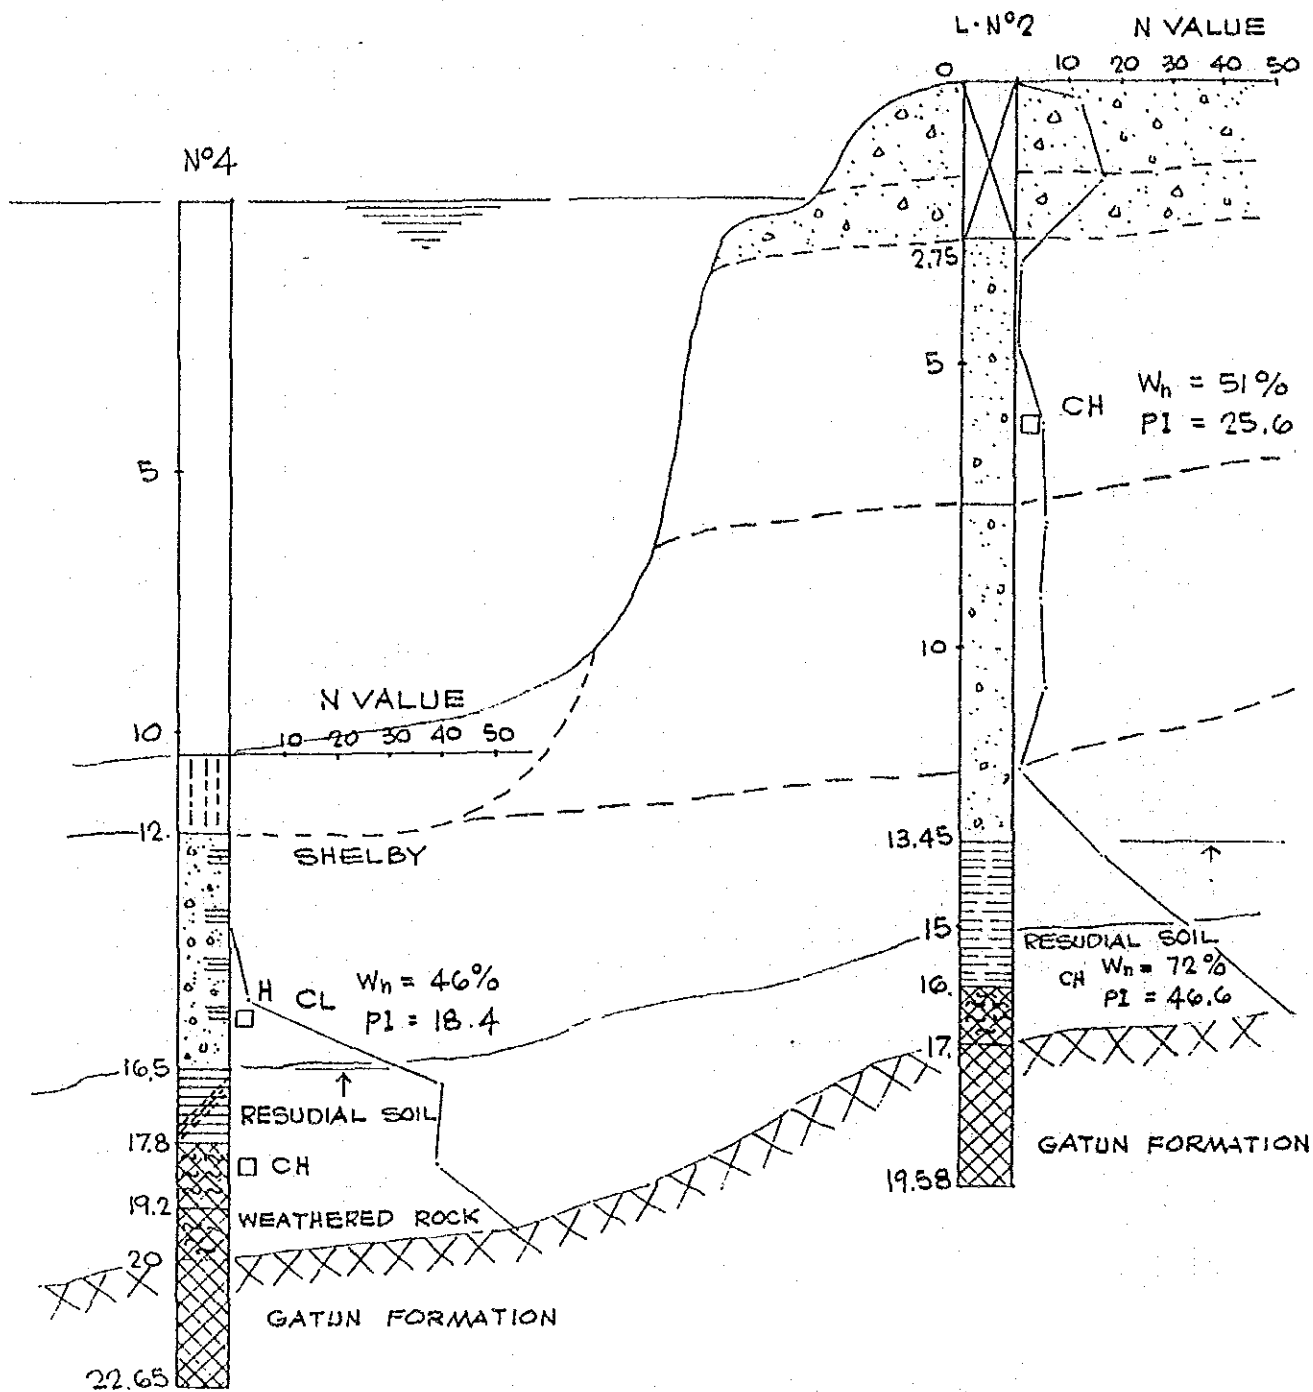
Perfil del Suelo en el Sitio - T
